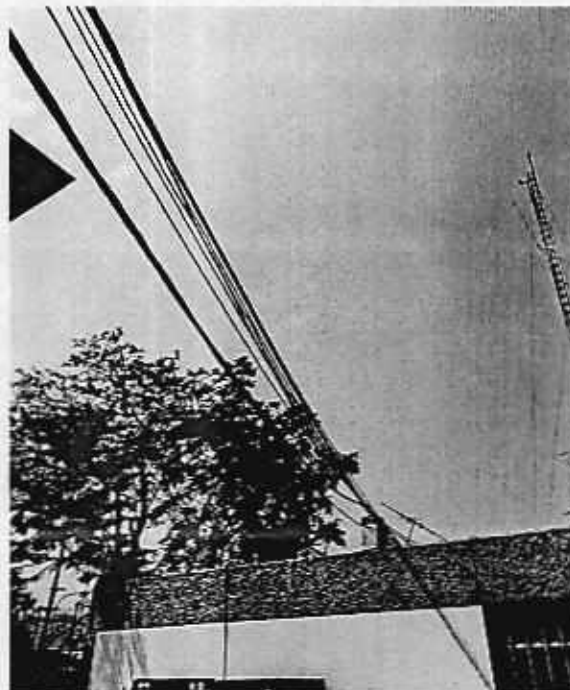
Vista de conexiones eléctricas expuestas exteriormente entre las edificaciones.
